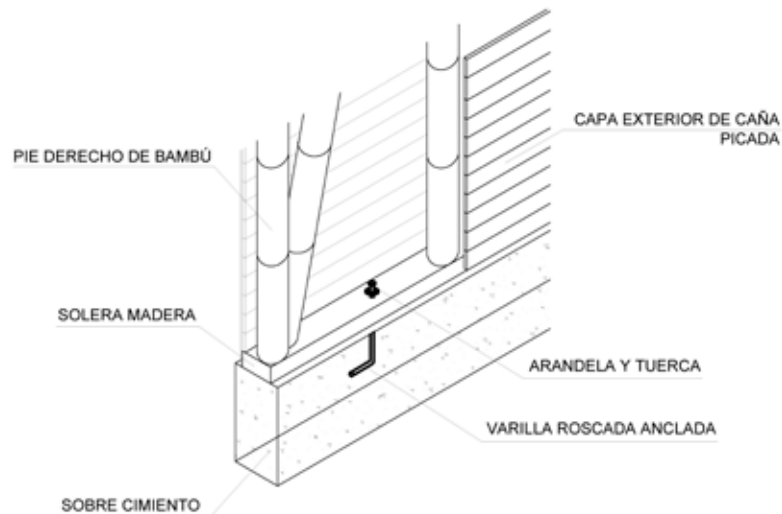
Unión muro de bahareque con solera de madera a cimiento. (Ministerio de la vivienda, construcción y saneamiento del Perú, 2012)
